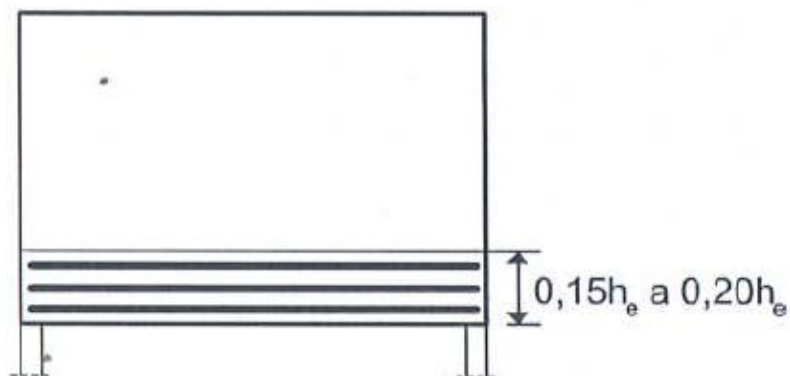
27 – Distribuição da armadura no banzo tracionado da viga-parede. (ARAÚJO, 2014).
